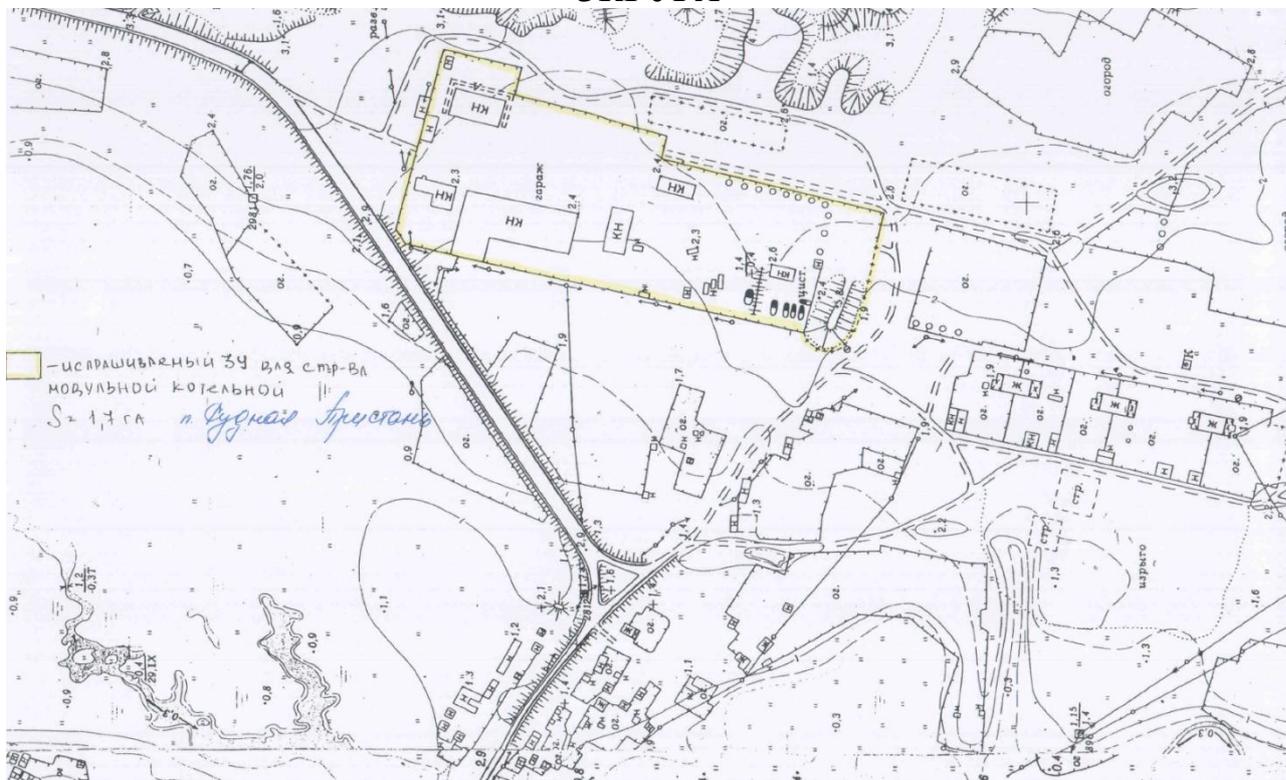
Схема расположения ЗУ под строительство котельной на кадастровом плане пос. Рудная Пристань
